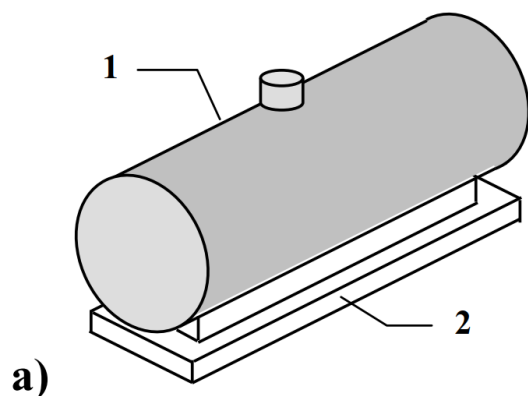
Циліндричний горизонтальний газгольдер: 1 – резервуар; 2 – суцільний фундамент
